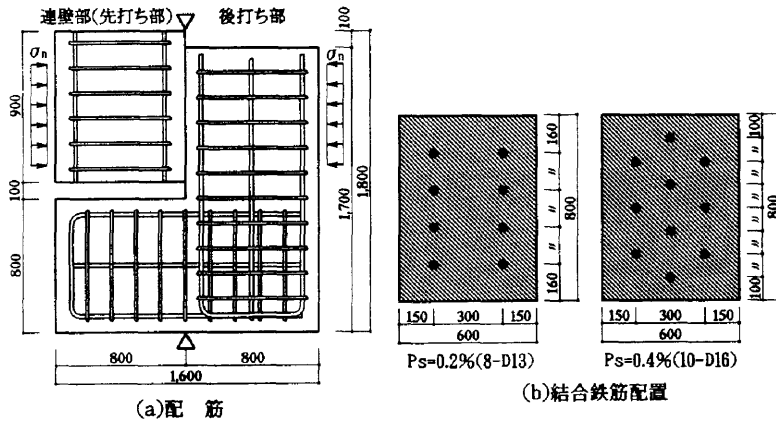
試験体配筋および結合鉄筋配置例 (実物試験体)
